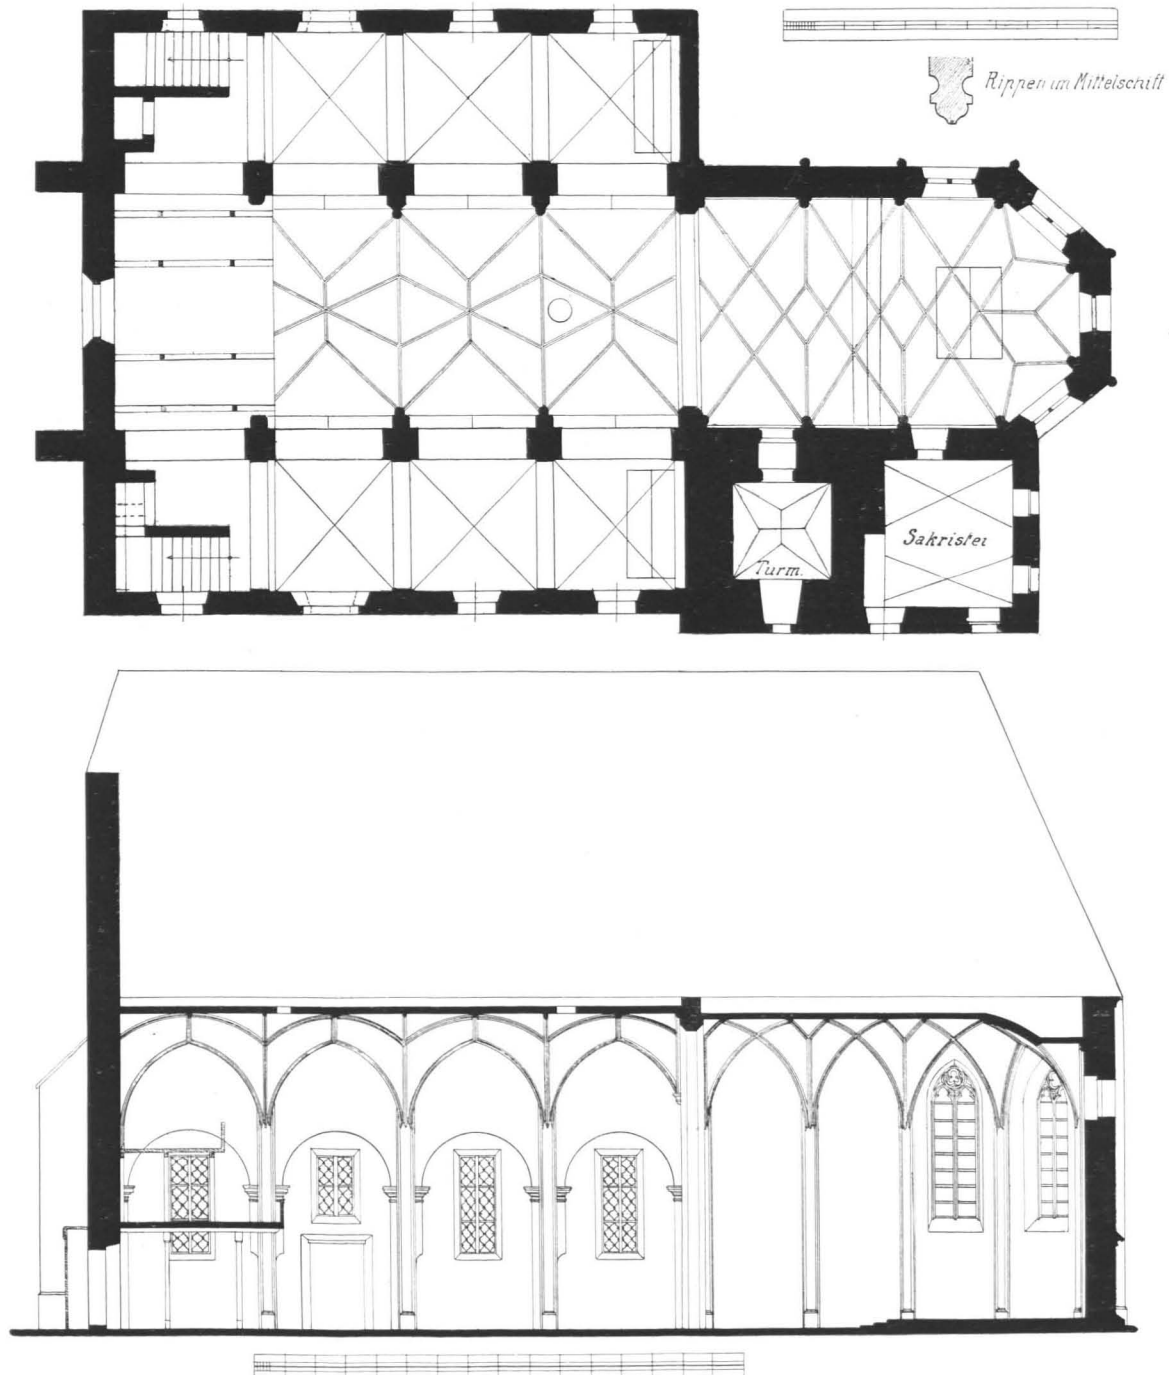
Straßwalchen, Pfarrkirche, Grundriß und Längsschnitt 1:250 (S. 170)
